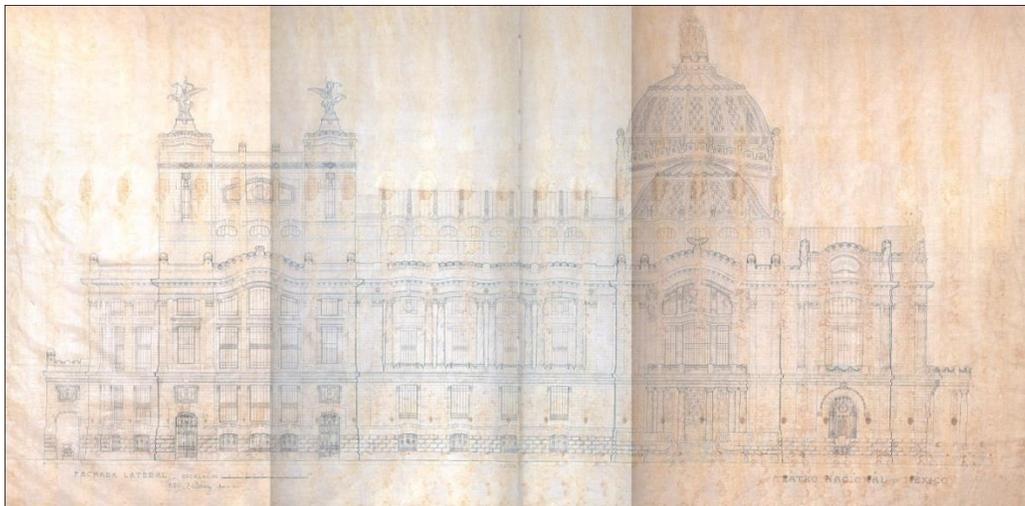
Figura IV.LII. Muestra del plano de la vista lateral del Palacio de Bellas Artes.<sup>223</sup>
